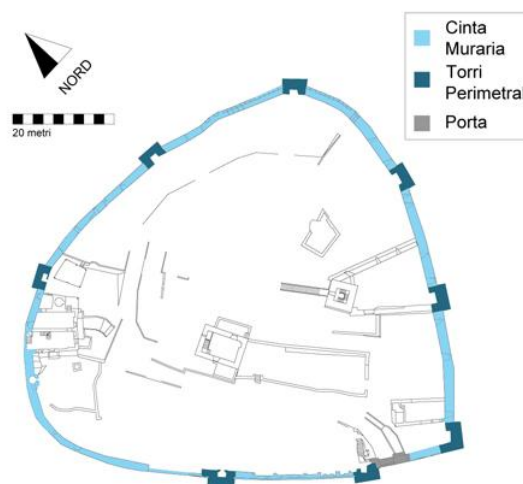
Pianta del castello di Montecchio con l'individuazione della cinta muraria, delle torri perimetrali e della porta di accesso.
